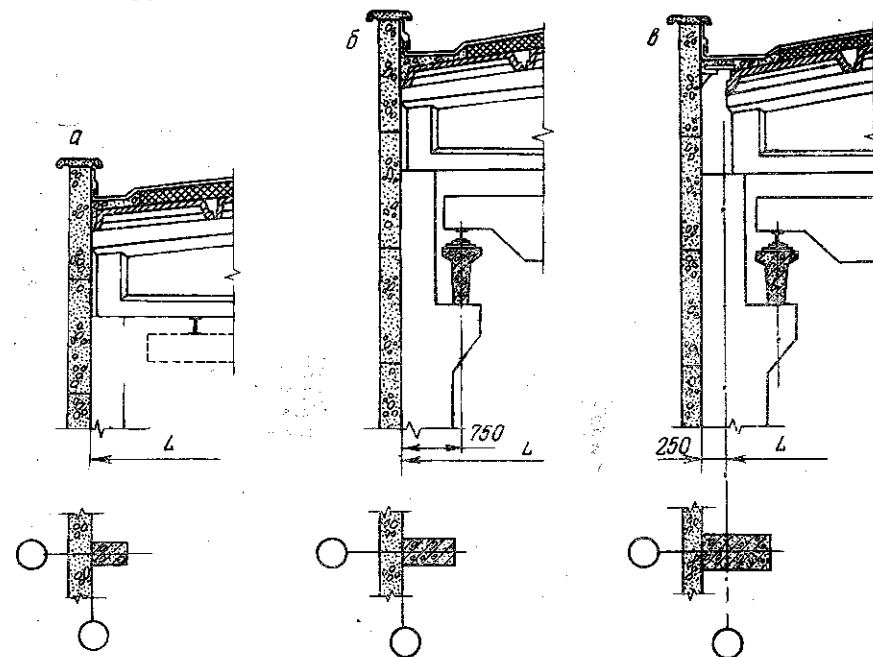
Привязка колонн и стен к продольным разбивочным осям
